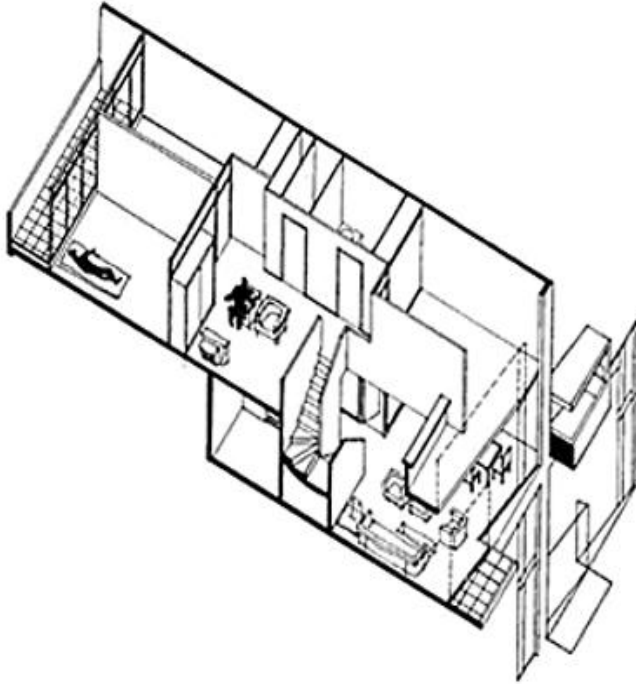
Plan se l'opération Les Foulards à Saint Pierre (Architecte Groupe IV) : stricte exposition NORD-SUD, circulations verticales décollées, plans traversants (sauf pour les petits types).
